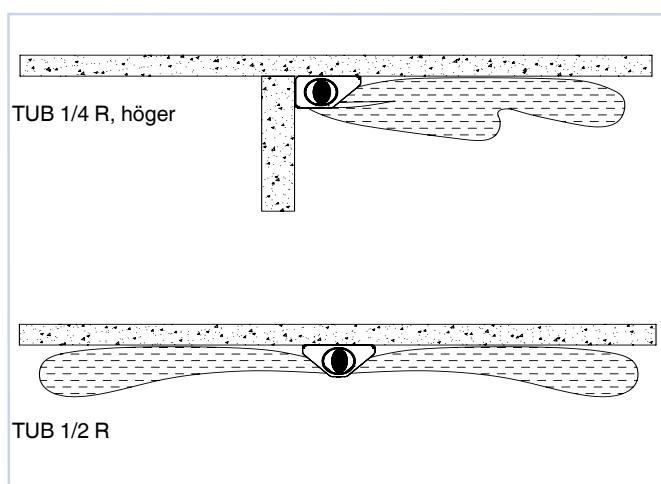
, TUB 1/2 R, spridningsmönster i plan.
